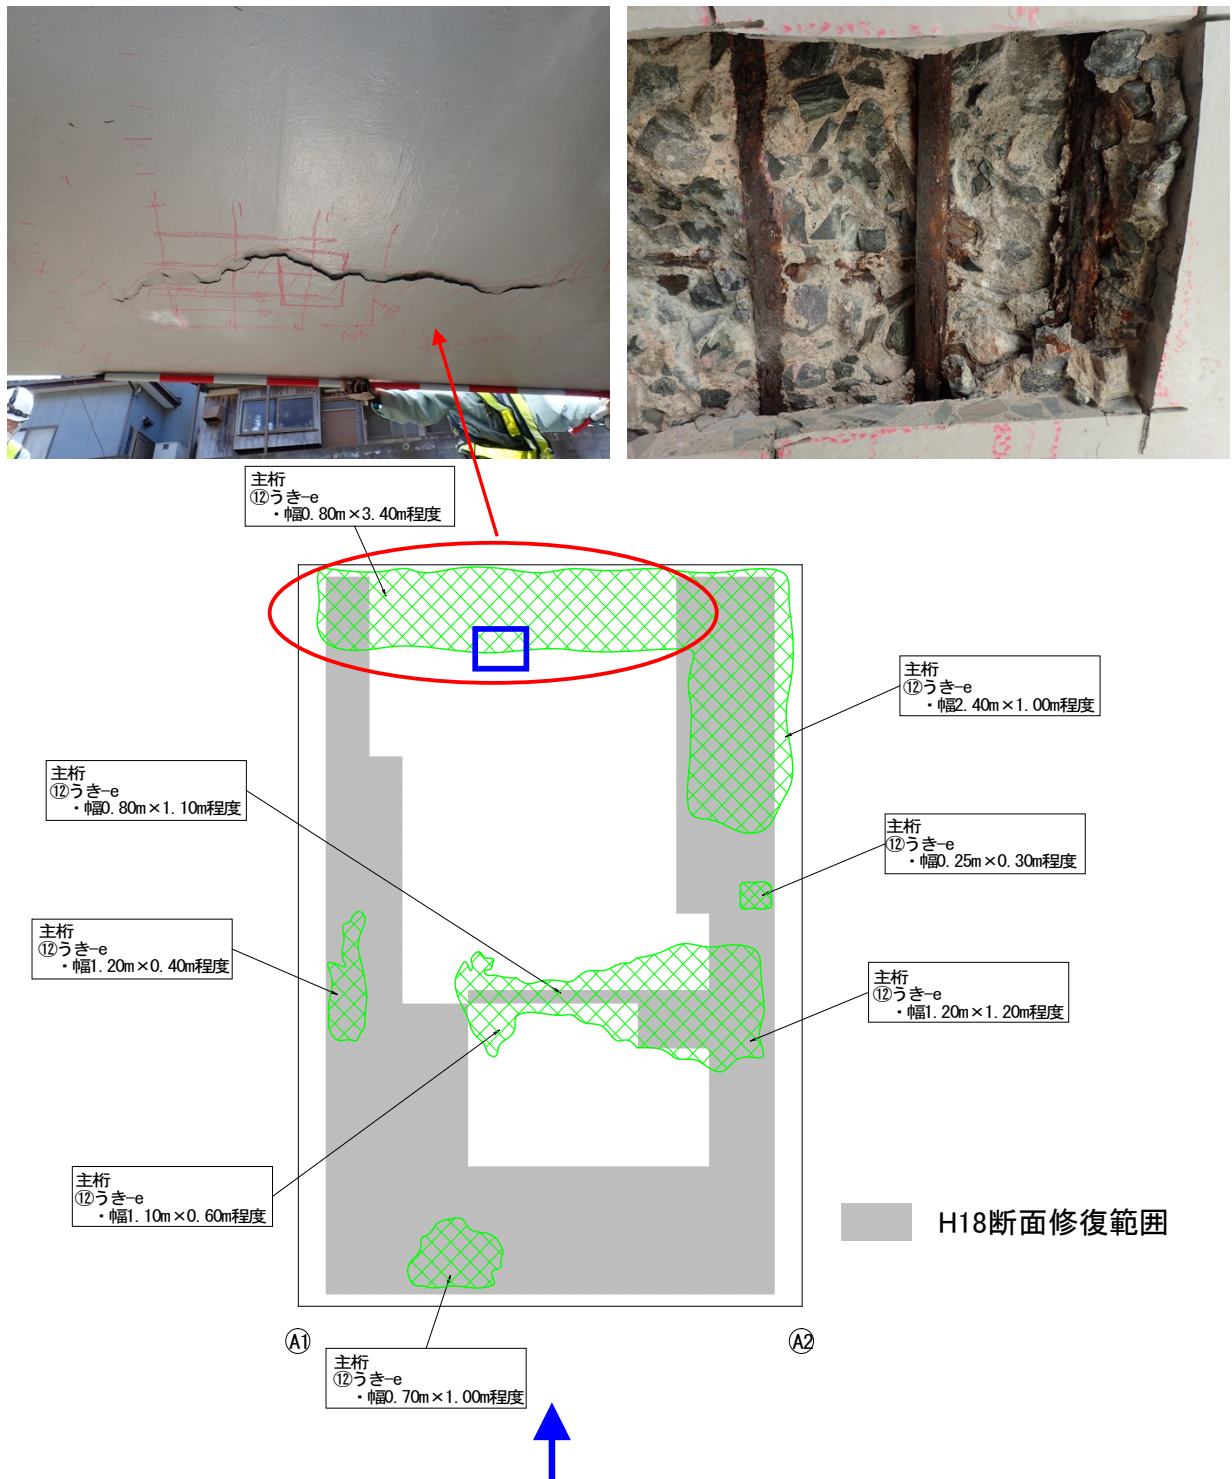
ひび割れ補修工（全断面コンクリート打替え工）の収縮ひび割れによる再劣化【事例】
